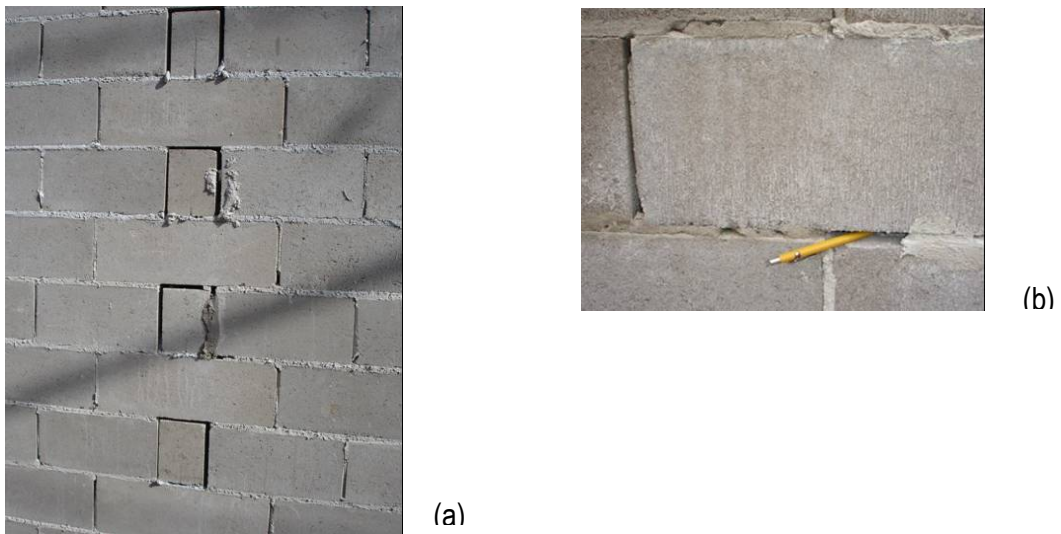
detalhes do preenchimento inadequado das juntas de argamassa
